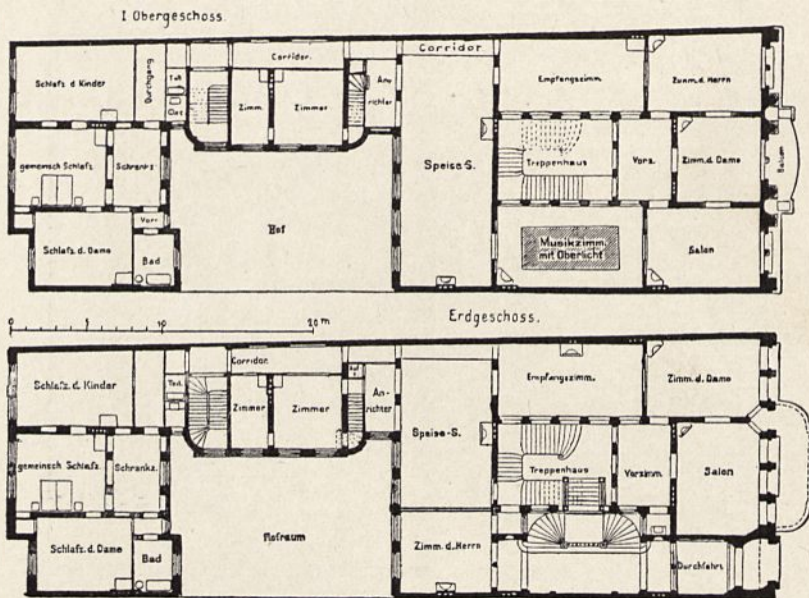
Wohnhaus Wallich in Berlin, Bellevuestraße.
